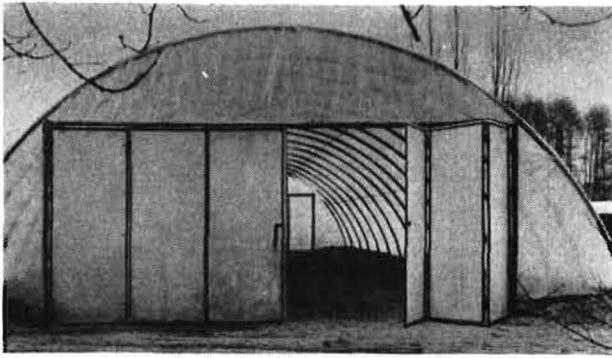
Plastfoliengewächshaus, Giebelansicht mit Falltüren
